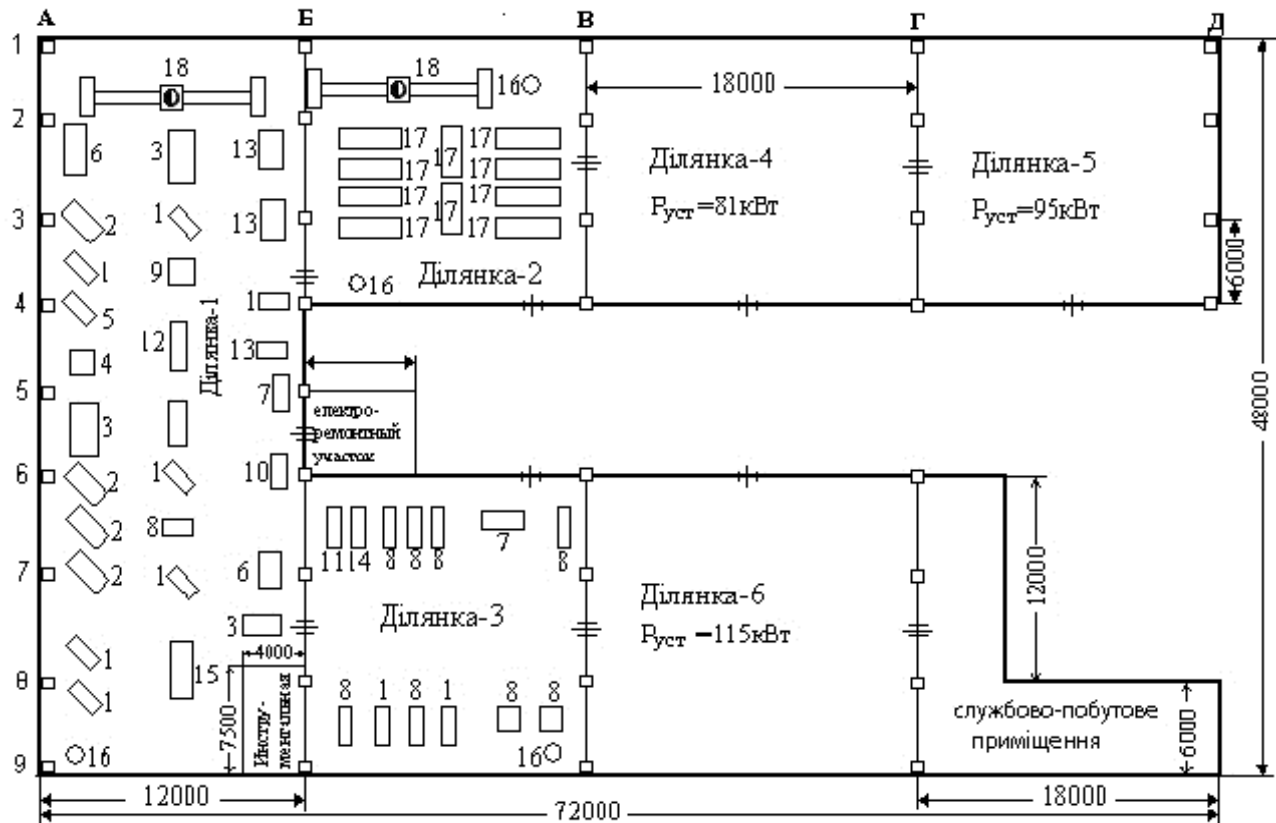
Схематичний план зварювально – механічного цеху.
